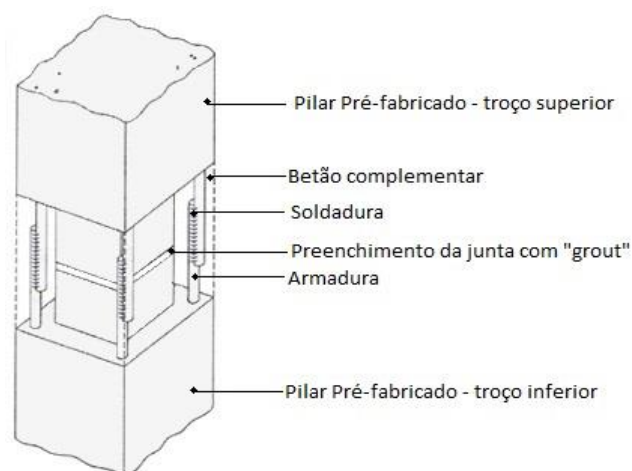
Ligação Pilar – Pilar por soldadura de varões de aço sobrepostos [46]
